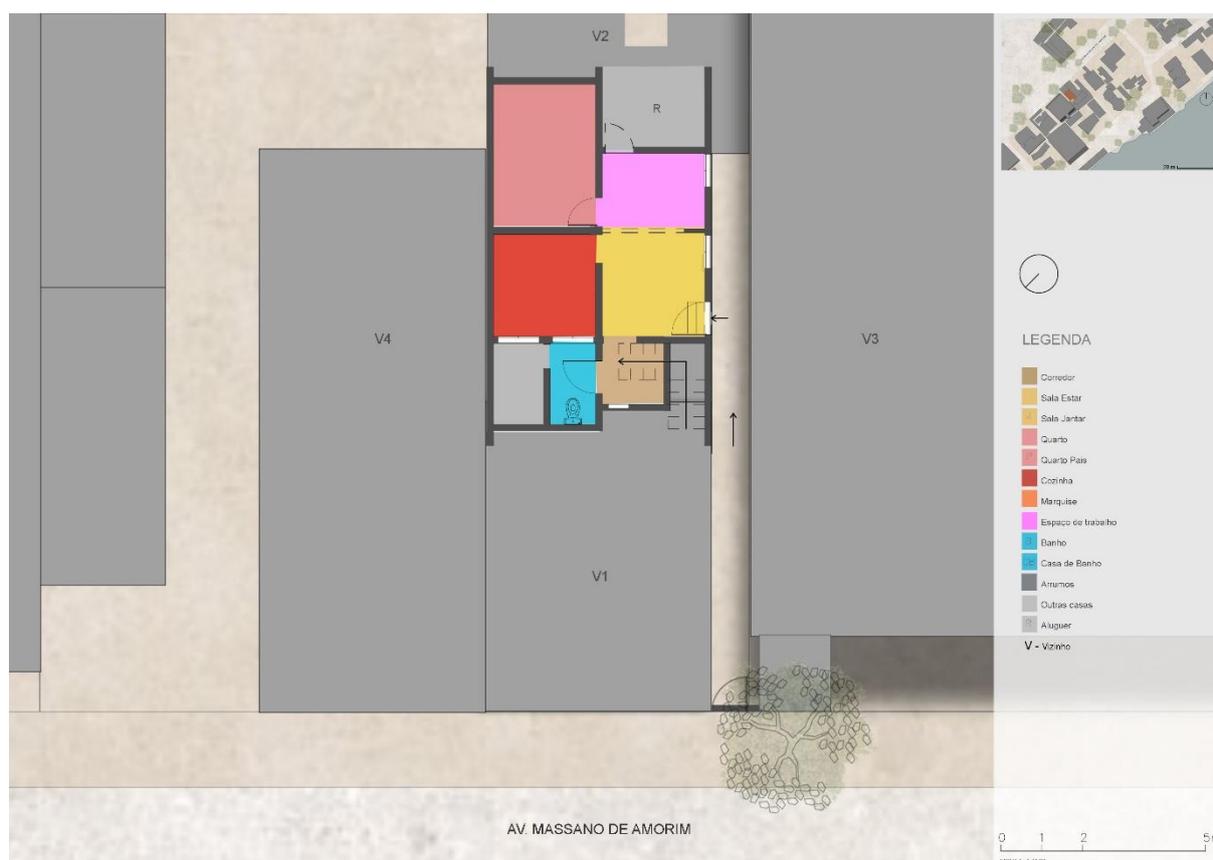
Planta r/c atual da Casa 3, em 2020. Levantado e projetado pela autora, 2020.
